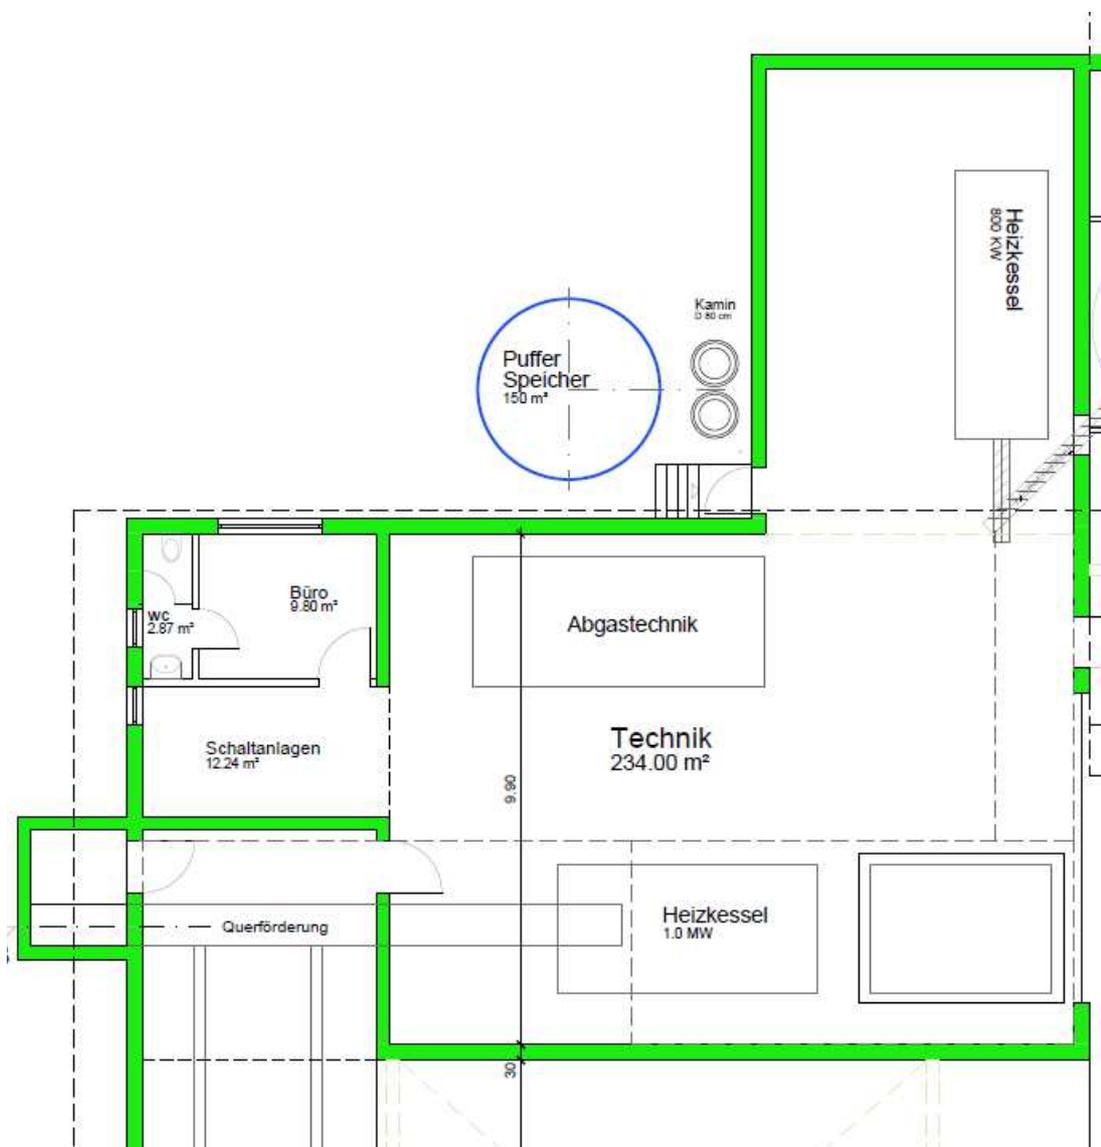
Grundriss Biomasse-Heizzentrale mit geplanten Holzheizkesseln
